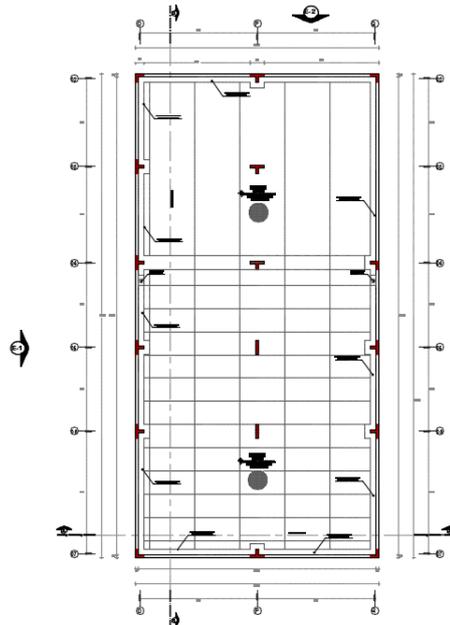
Plano de techos - Bloque B – Zona de rehabilitación
